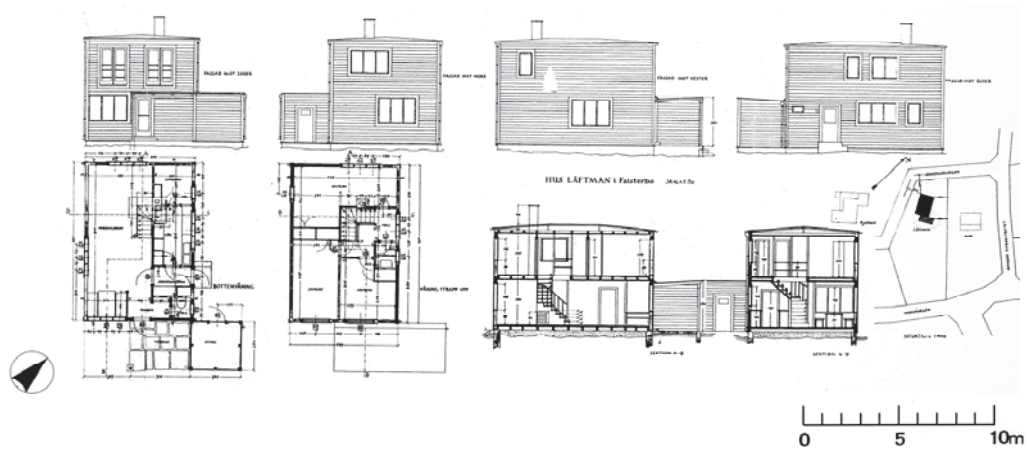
ヴィラ・ローフトマン 平面図・立面図・断面図・配置図
